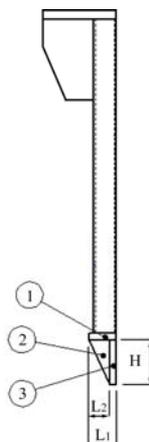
Dispositivo di attacco a struttura tubolare e disposizione verticale dei punti di ancoraggio (1 piastra orizzontale, 2 flangie di rinforzo, 3 piastra verticale).
